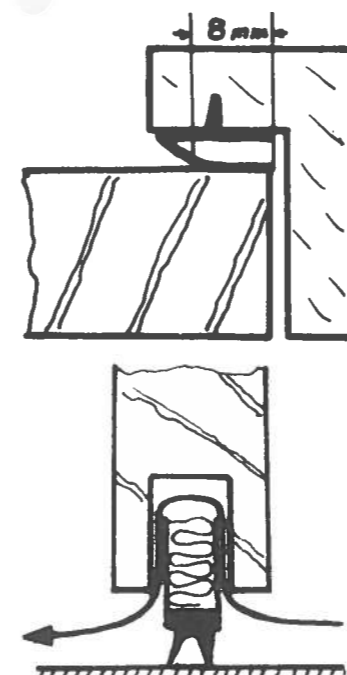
Richtige Ausbildung einer Lippendichtung. Die Lippe soll sich auf einer Länge von ca. 8 mm an das Türblatt anschmiegen.
